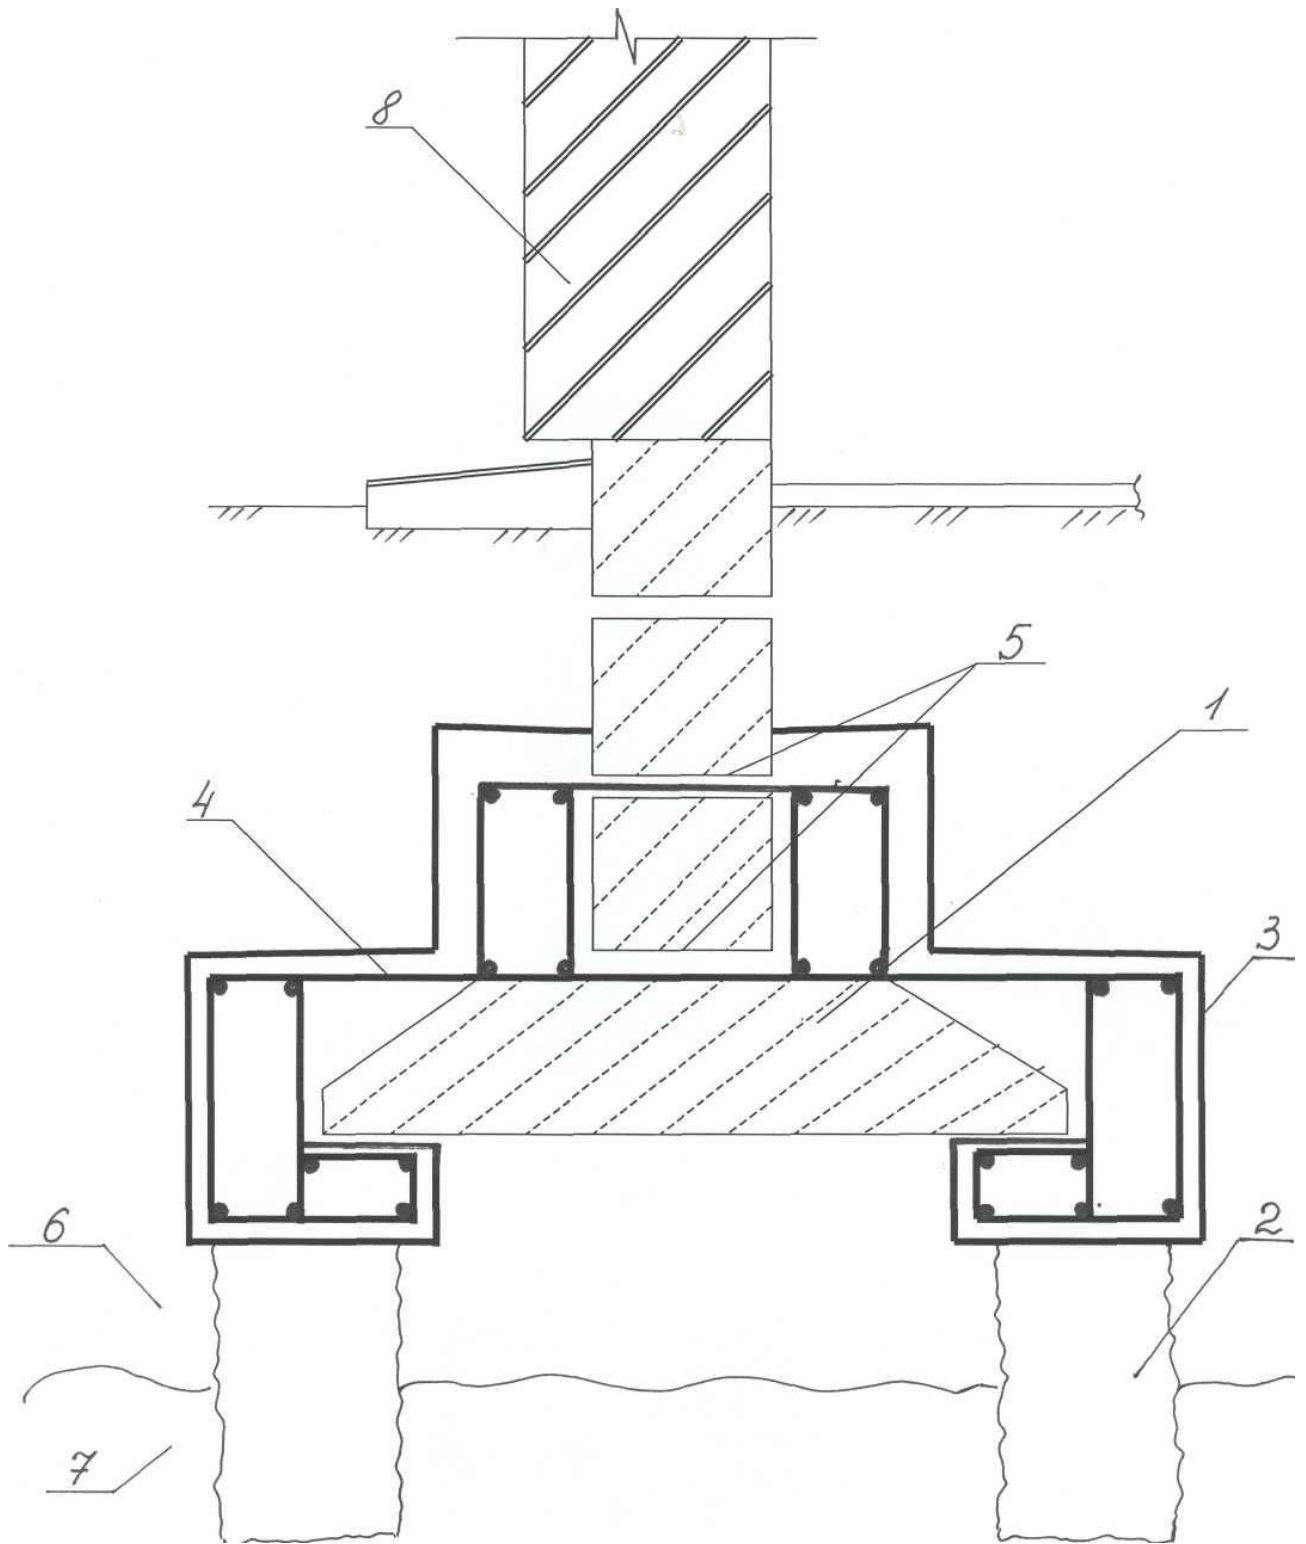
Передача нагрузки от фундамента на буронабивные (буровые) сваи
